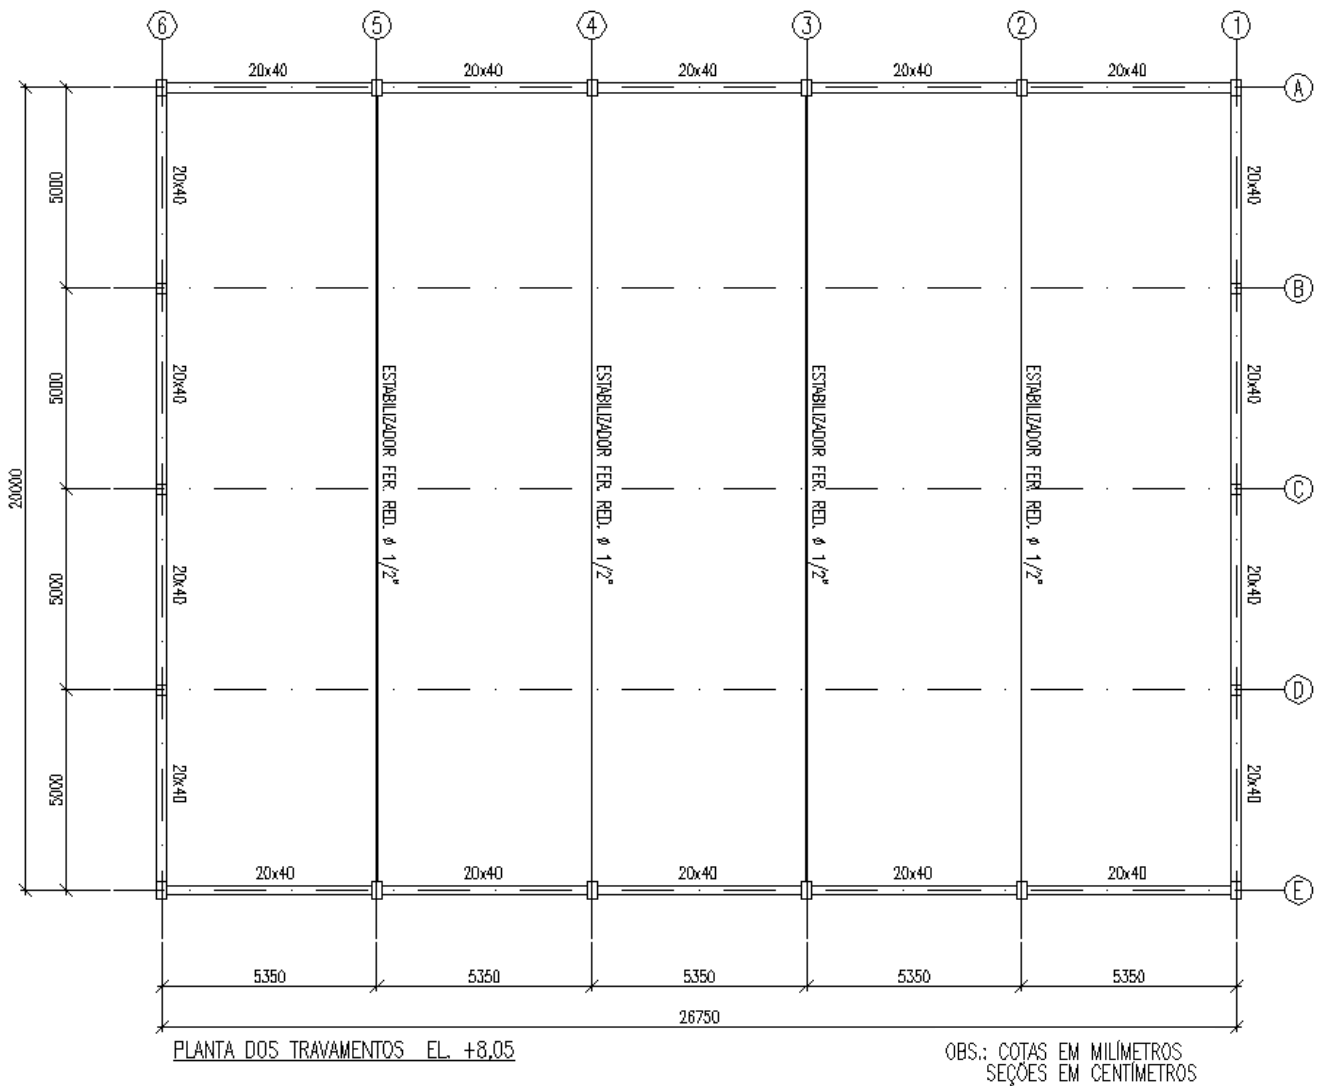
Planta de localização dos travamentos para estrutura em concreto pré-moldado.
